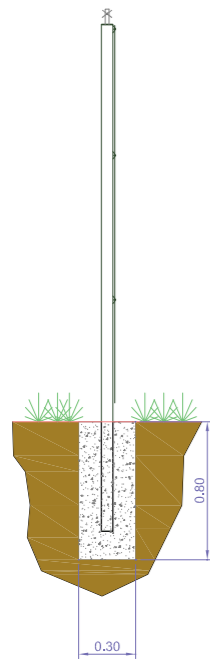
DETAILS - ÉLÉVATIONS DU PORTAIL D'ENTRÉE ET DE LA CLÔTURE - échelle 1/40e
